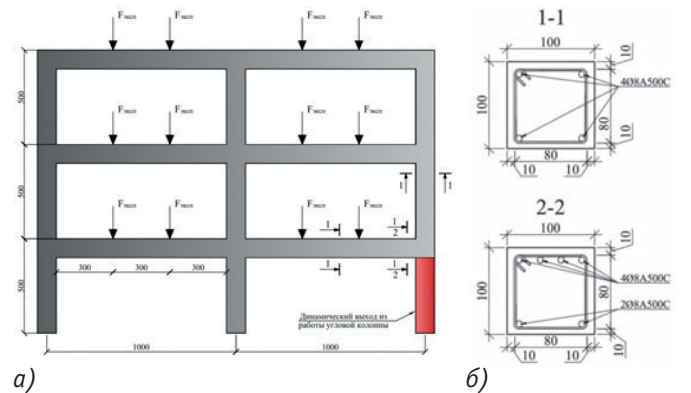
Исходные данные для моделирования: а) расчётная схема железобетонной рамы, б) армирование элементов рамы
